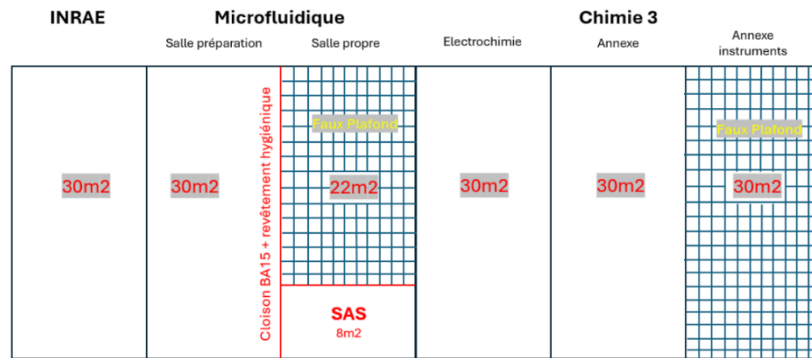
Extrait Note de Faisabilité - Zone de Faux Plafonds
